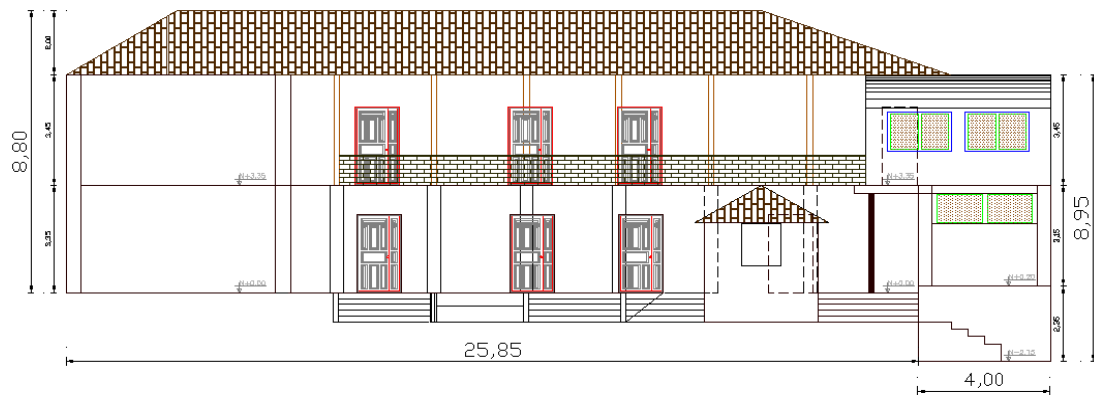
Fachada lateral izquierda interna 2D de la estructura
